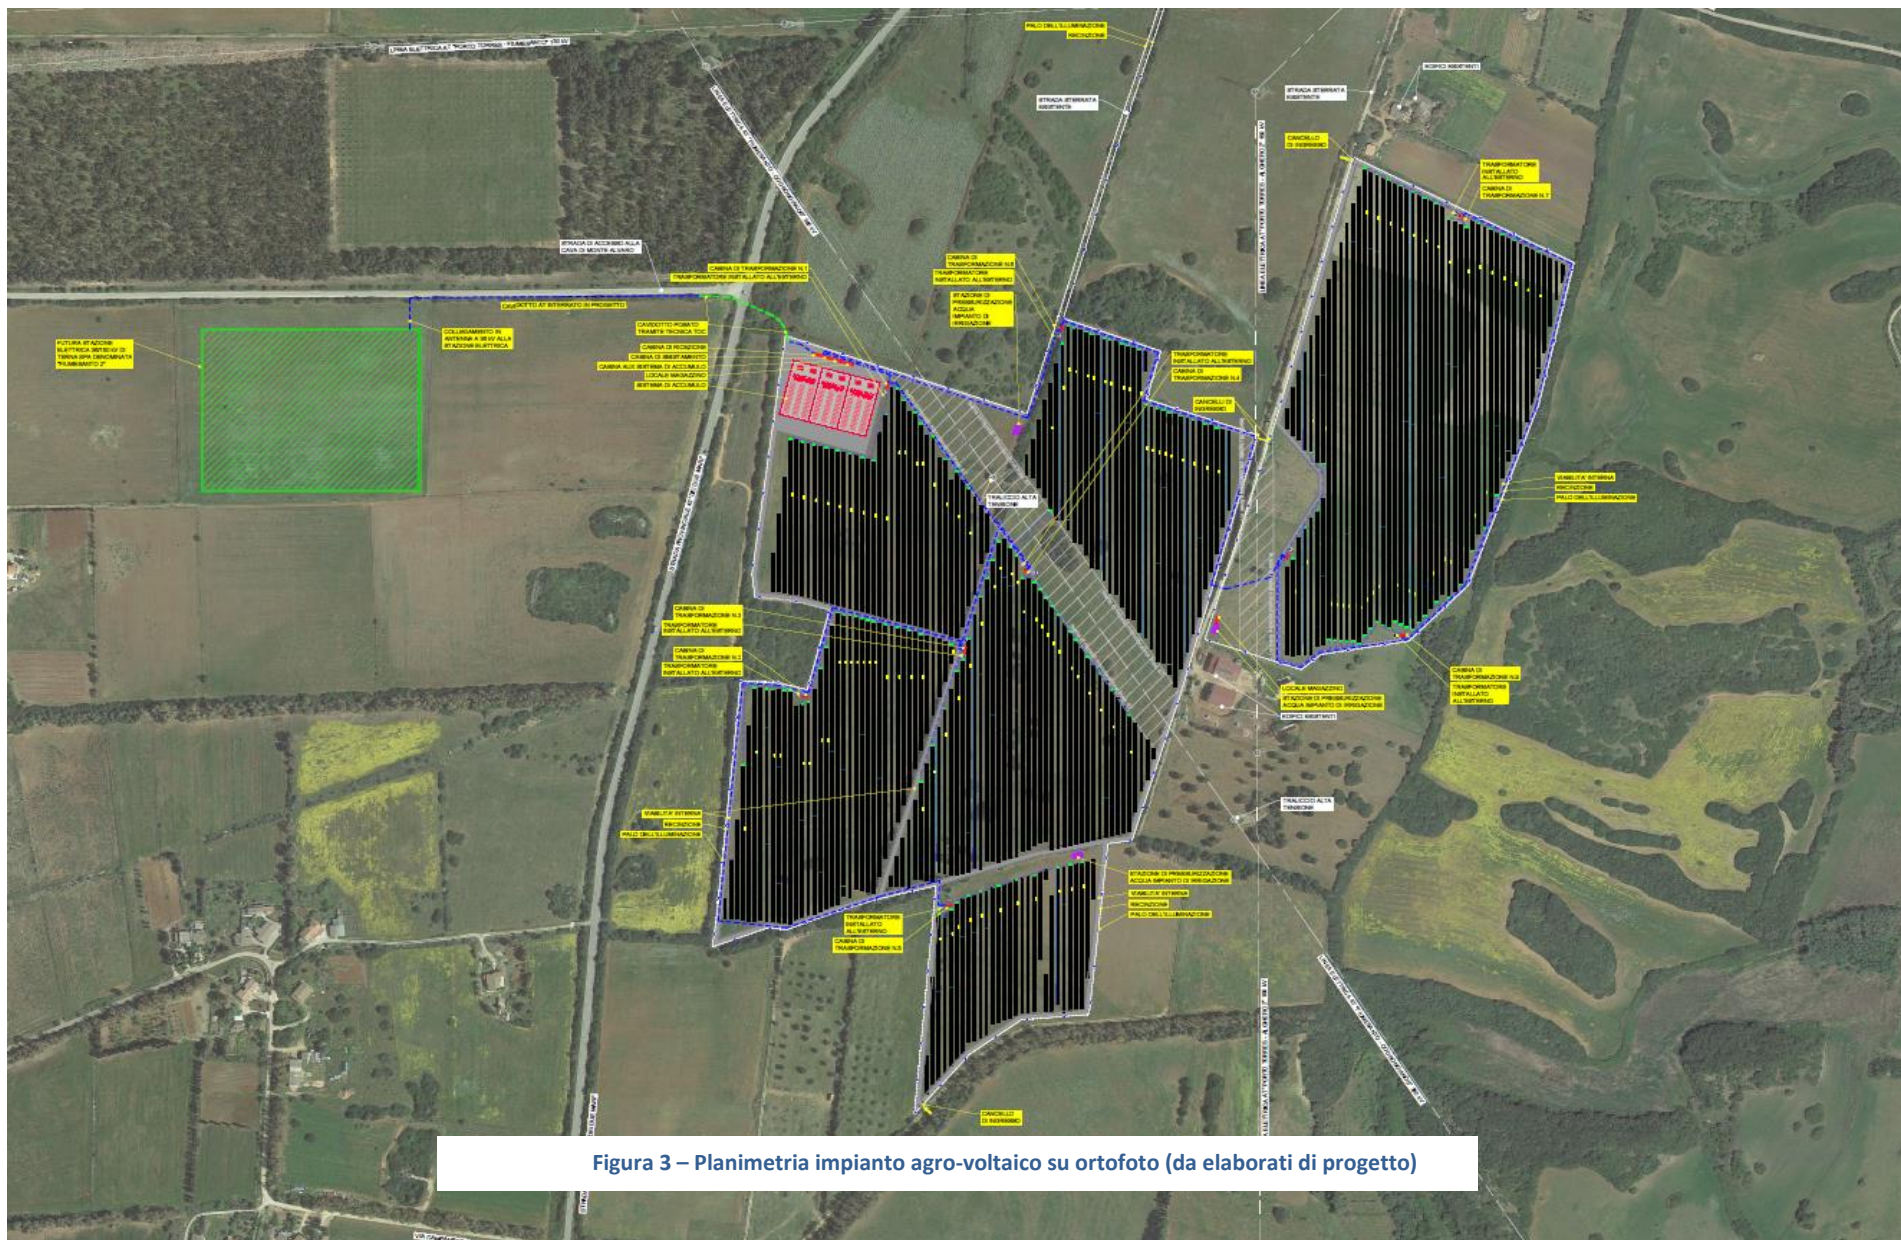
Planimetria impianto agro-voltaico su ortofoto (da elaborati di progetto)
